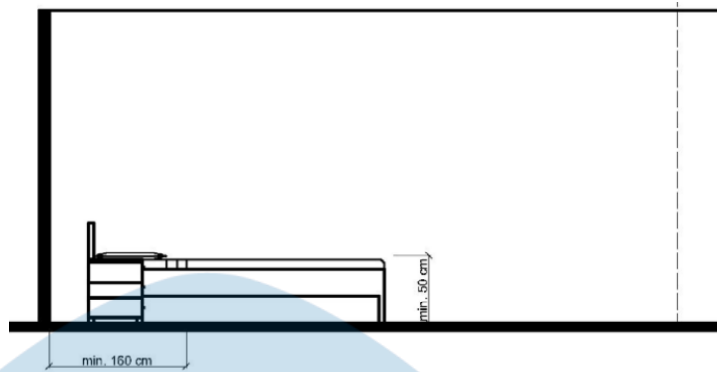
Standar perabot ruang tidur dengan layout ranjang tunggal
